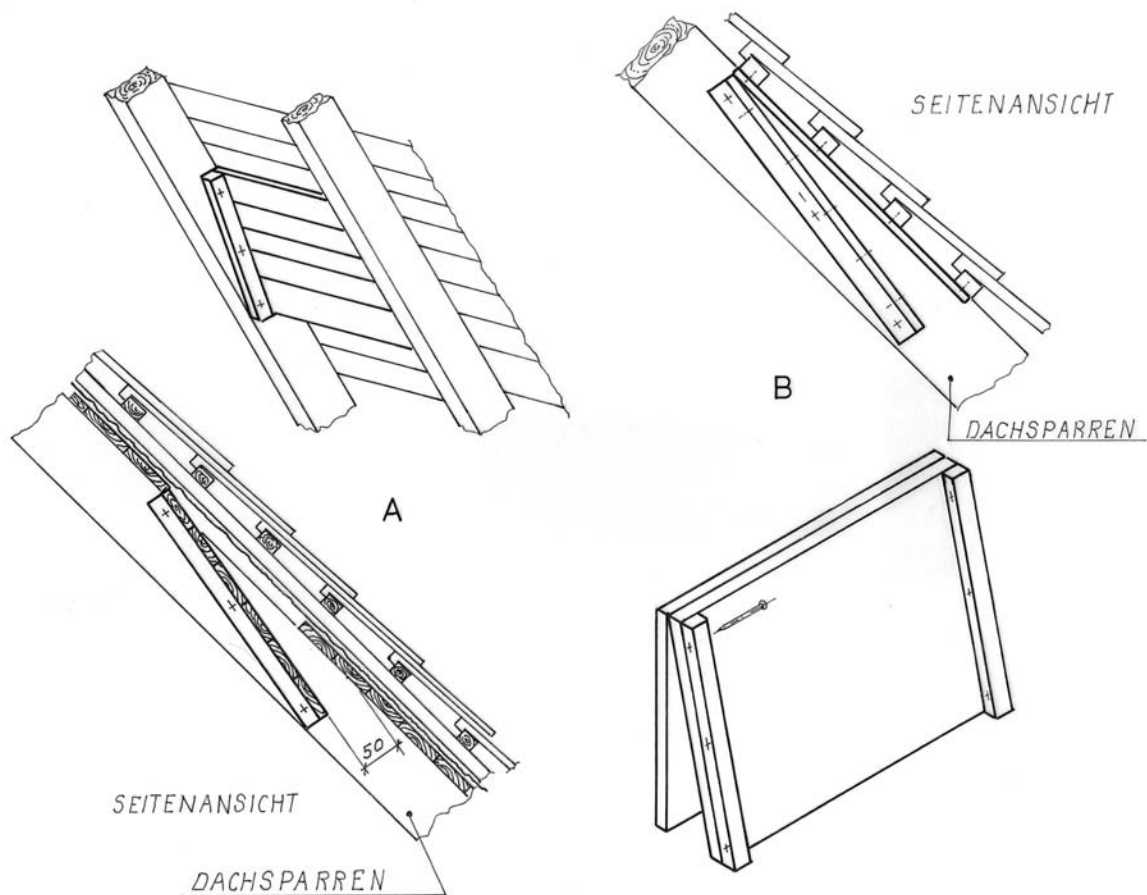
Einbau von Fledermausverstecken zwischen die Dachsparren. Ist eine Dachabdeckung aus mehreren Lagen vorhanden (A), ist es günstig, die untersten Lagen (Dachlatten) zu entfernen, um die Erwärmung des Verstecks bei Sonneneinstrahlung zu beschleunigen. Fehlen unter den Dachziegeln weitere Schichten (B), können Fledermausbretter mit einer Rückwand zwischen den Dachbalken angebracht werden (Maßangaben in mm).
